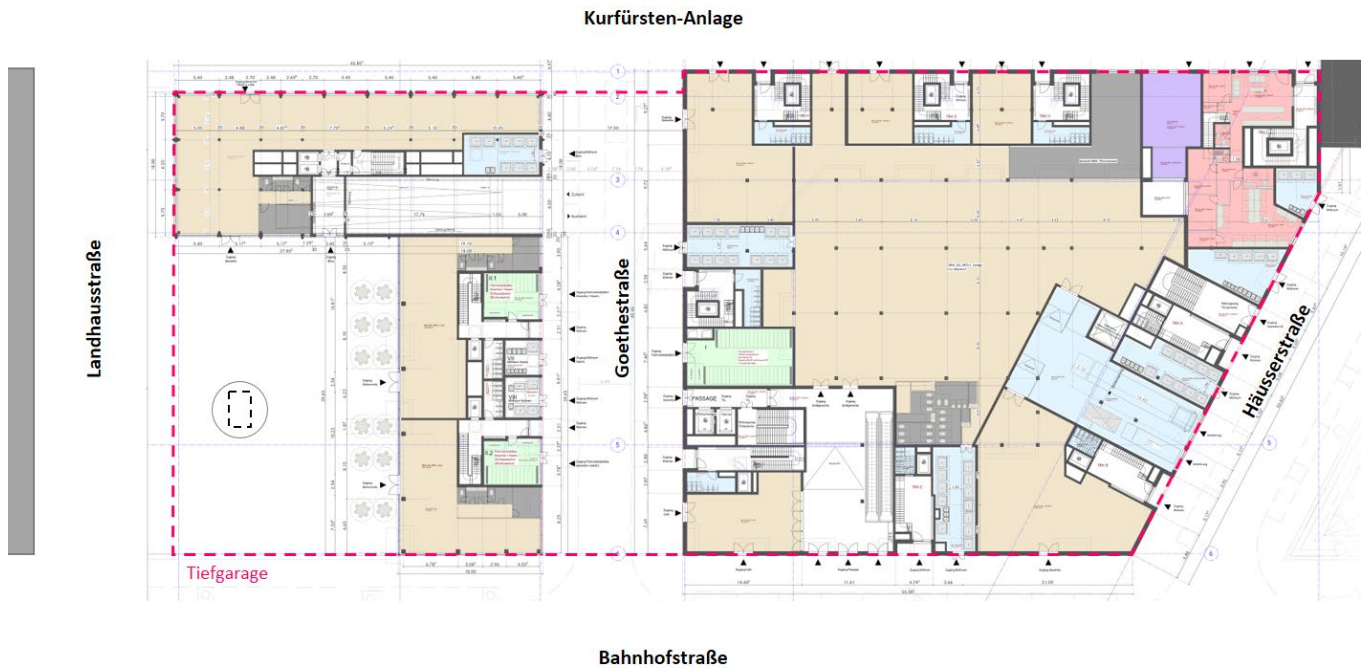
Erdgeschoss Hochbauplanung und Umgrenzung Tiefgarage
